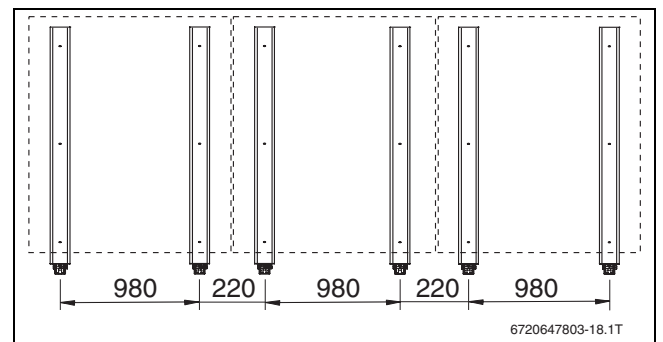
Modelo para cargas mais elevadas, 3 colectores verticais
